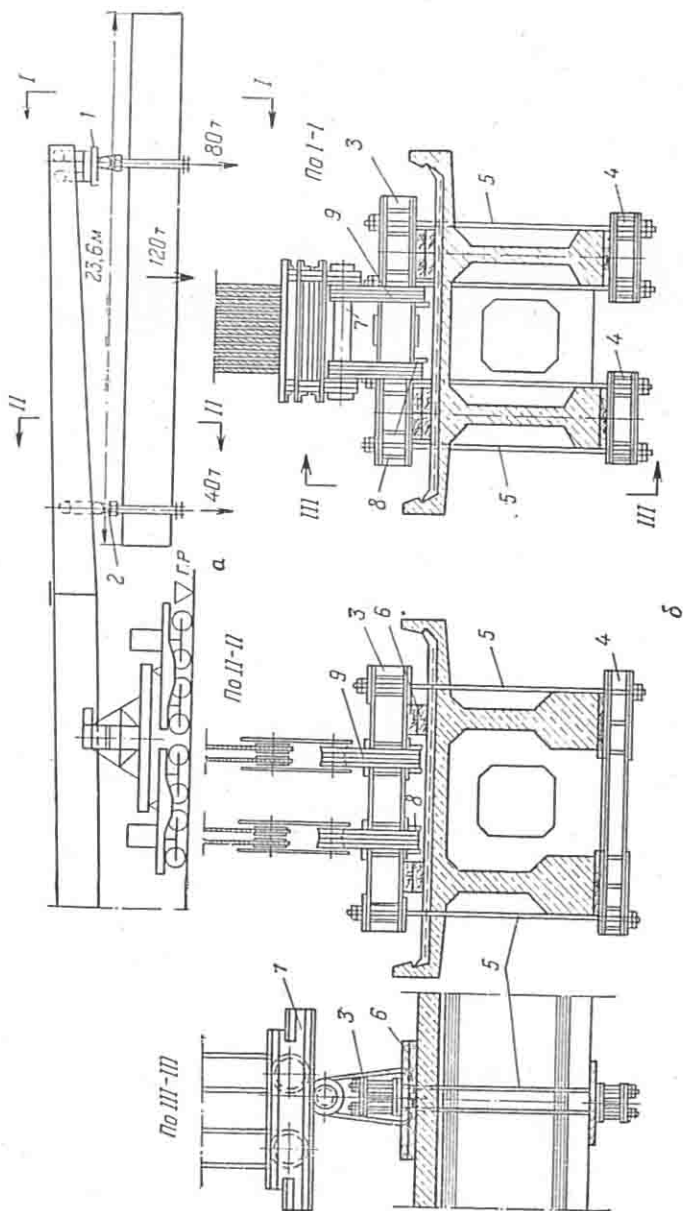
Строповка железобетонного пролетного строения весом 120 т к консольному крану ГЭК-120:
